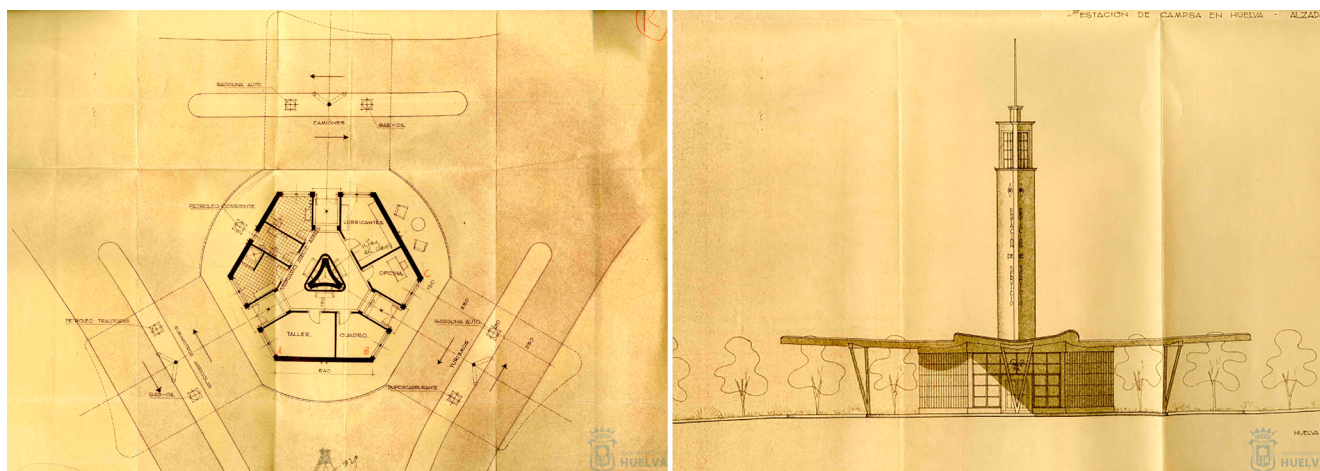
Planta y alzado original del “Proyecto de Estación de Servicio para CAMPSA en Huelva”, arquitecto Alejandro Herrero Ayllón (1955-1959). AMH_FAHA, leg. 91 (Alejandro Herrero Ayllón, AMH_FAH) (12)
